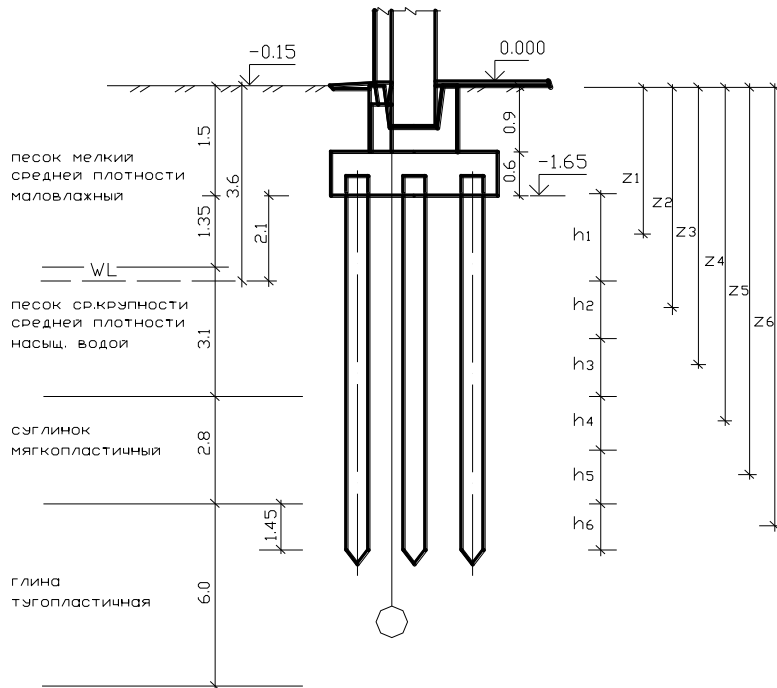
Сечение свайного фундамента под колонну каркаса. (В формате WMF)
